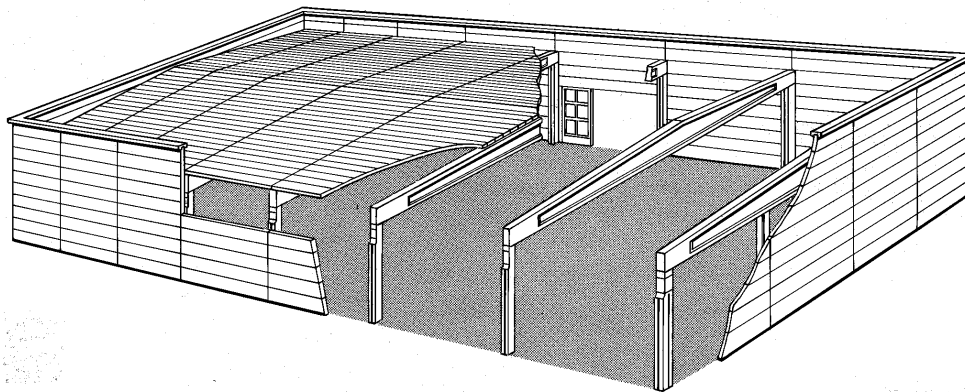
Schematisch voorbeeld van een industrieel gebouw met portiekconstructie
